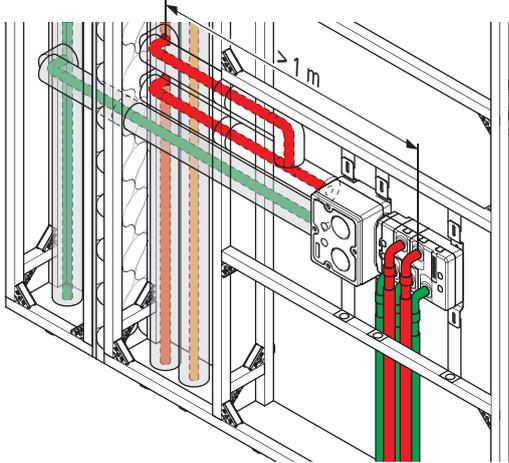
Conduite d'eau chaude avec un bouclage jusqu'au niveau du boîtier robinetterie à montage caché
